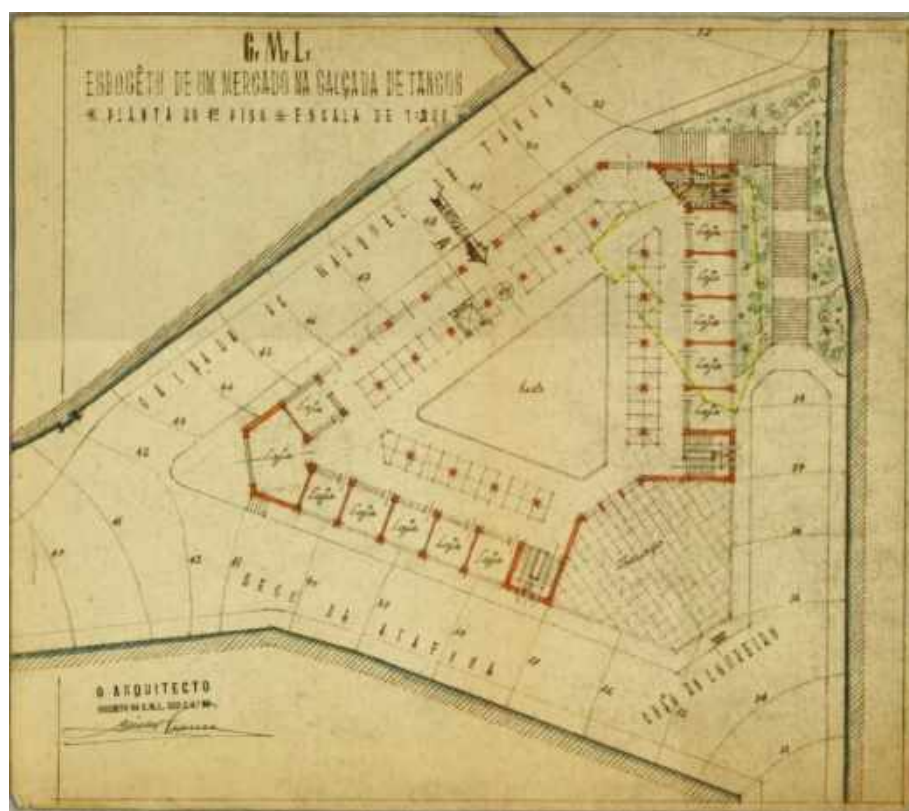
Esboço da Planta de Cobertura do Mercado do Chão do Loureiro (Franco, 1947, p.32)
